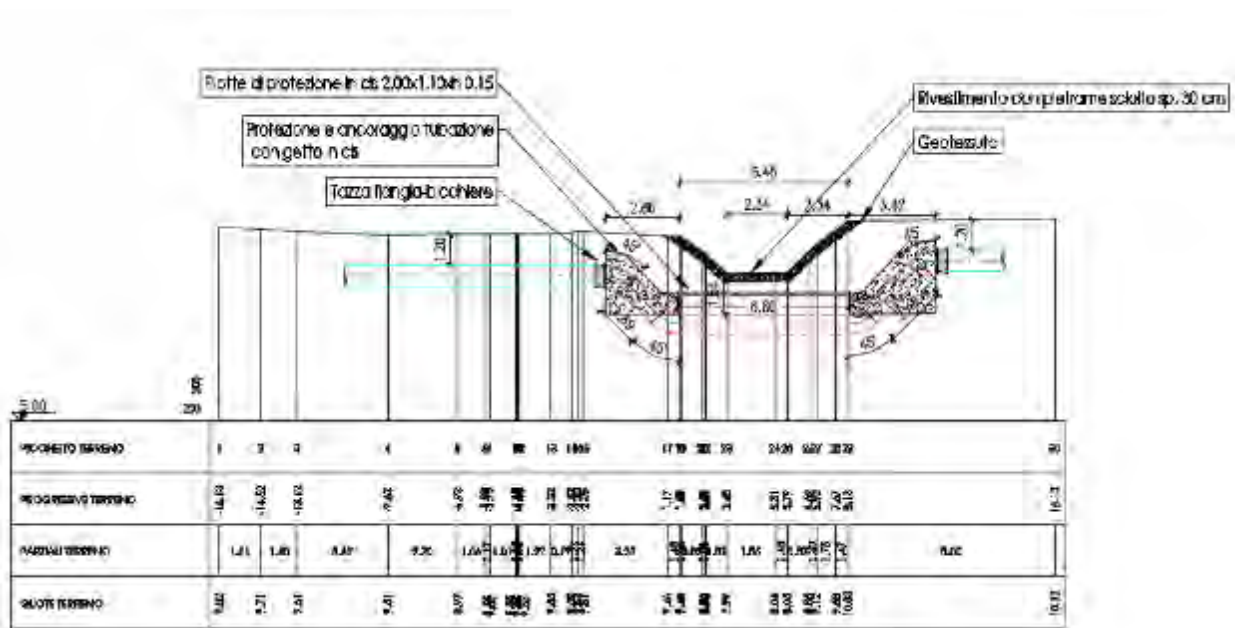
Sezione tipo di attraversamento di uno scolo consortile con sifone in acciaio
